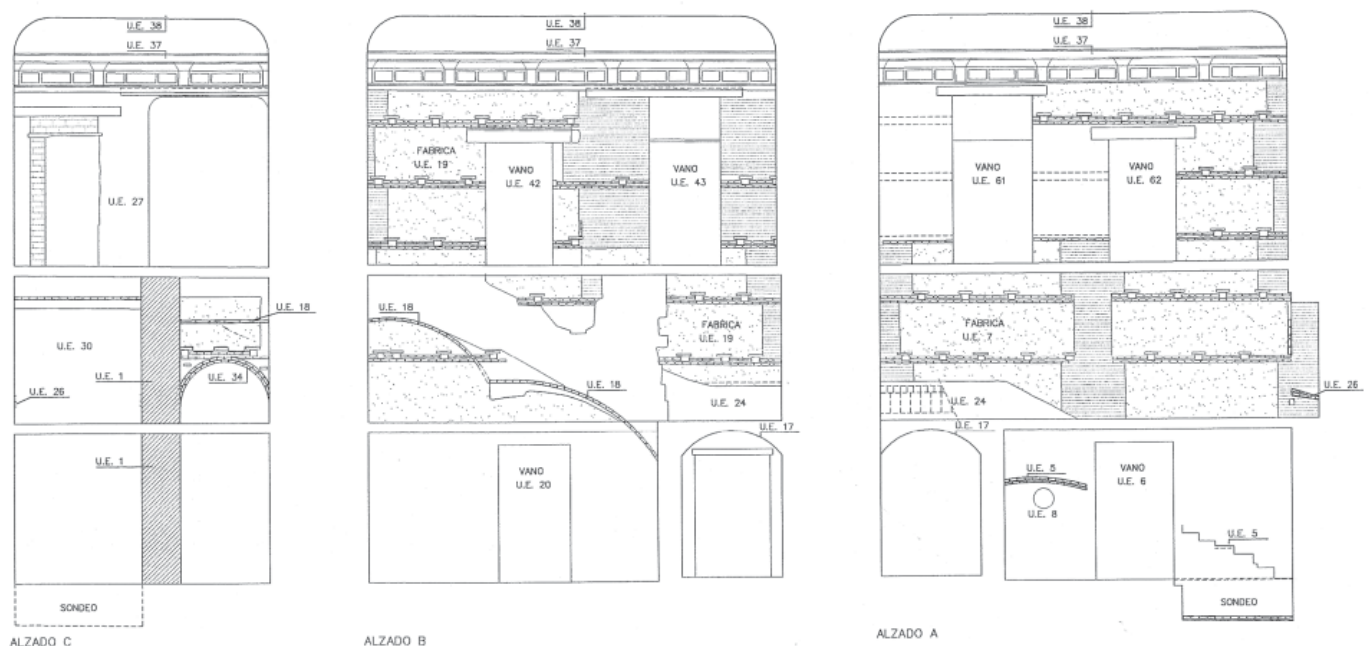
Alzado de la caja de escalera. Conjunto de estructuras.
